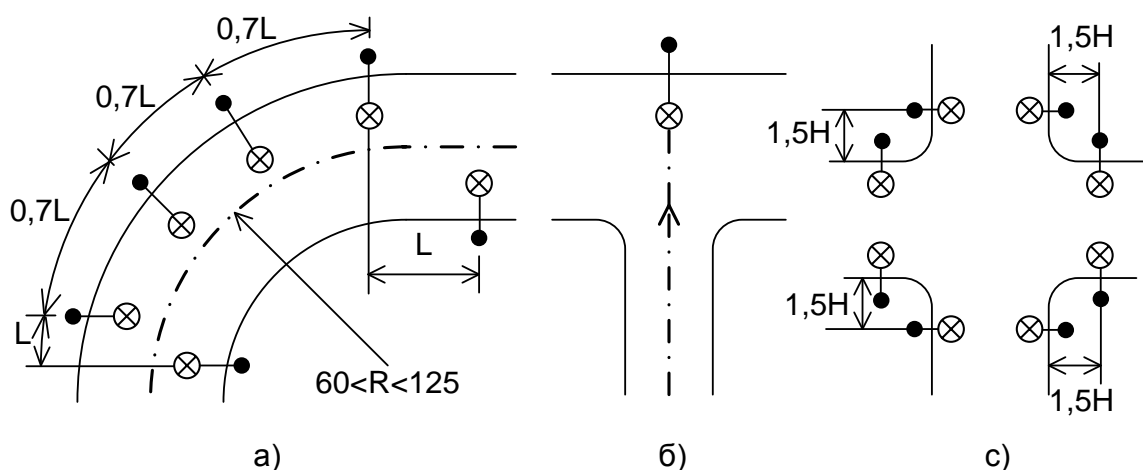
Схема расположения светильников: а) на закруглении; б) на примыкании; в) на пересечении; H – высота установки светильников.
